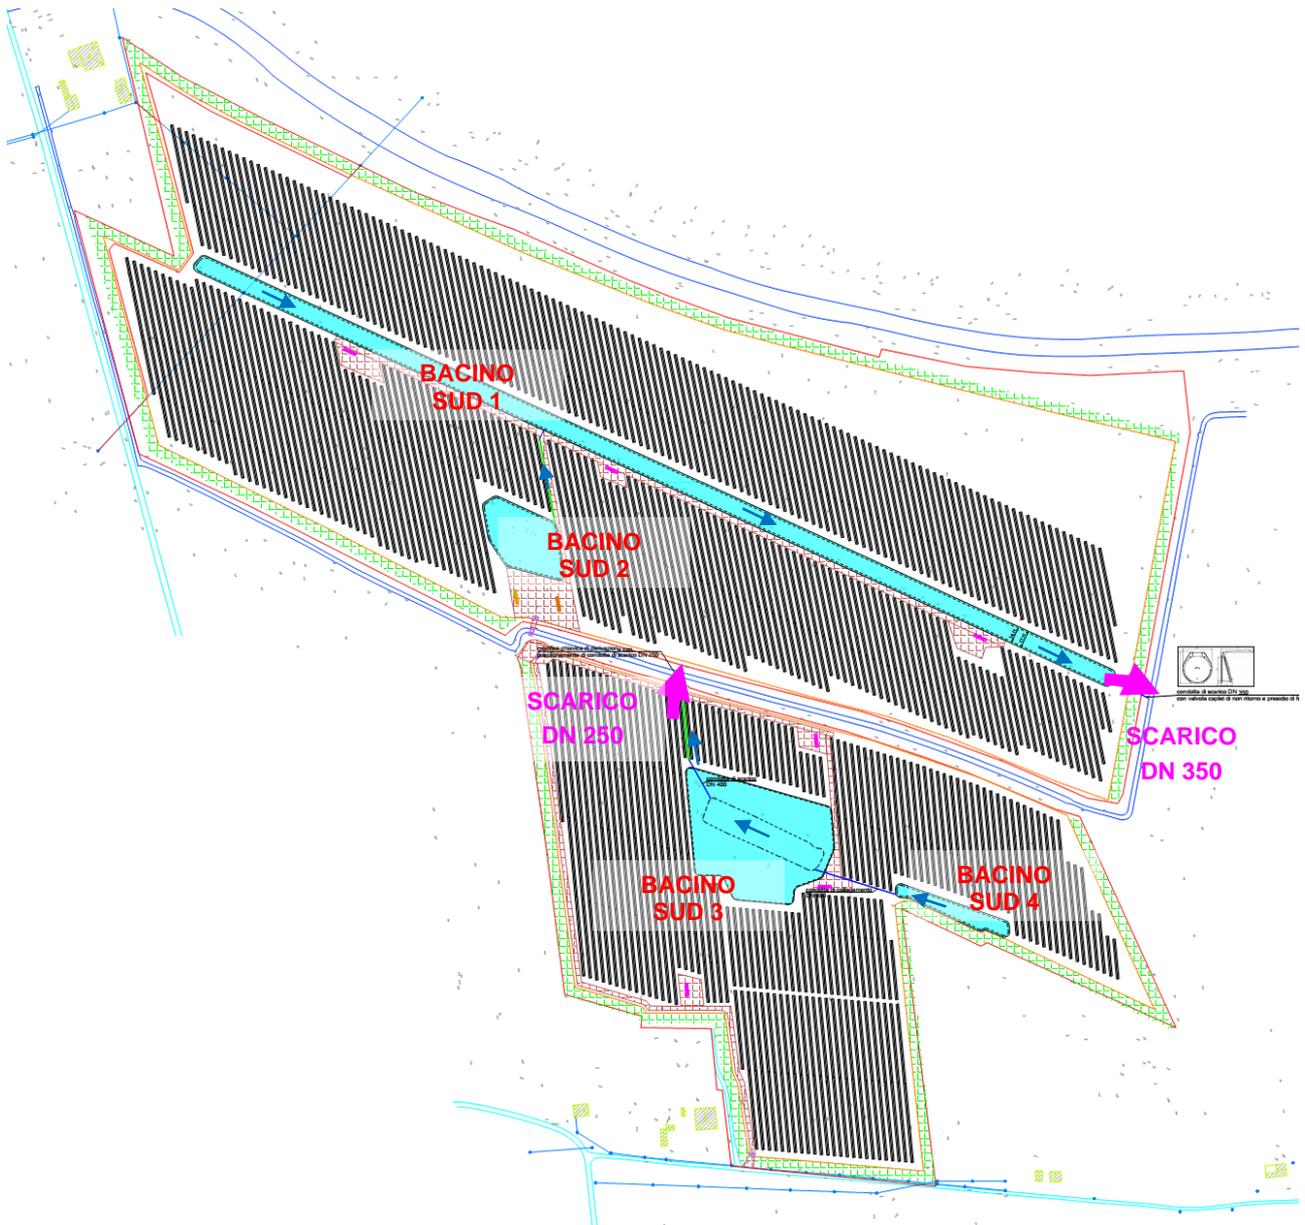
Schema impianto drenaggio acque meteoriche AREA sud
